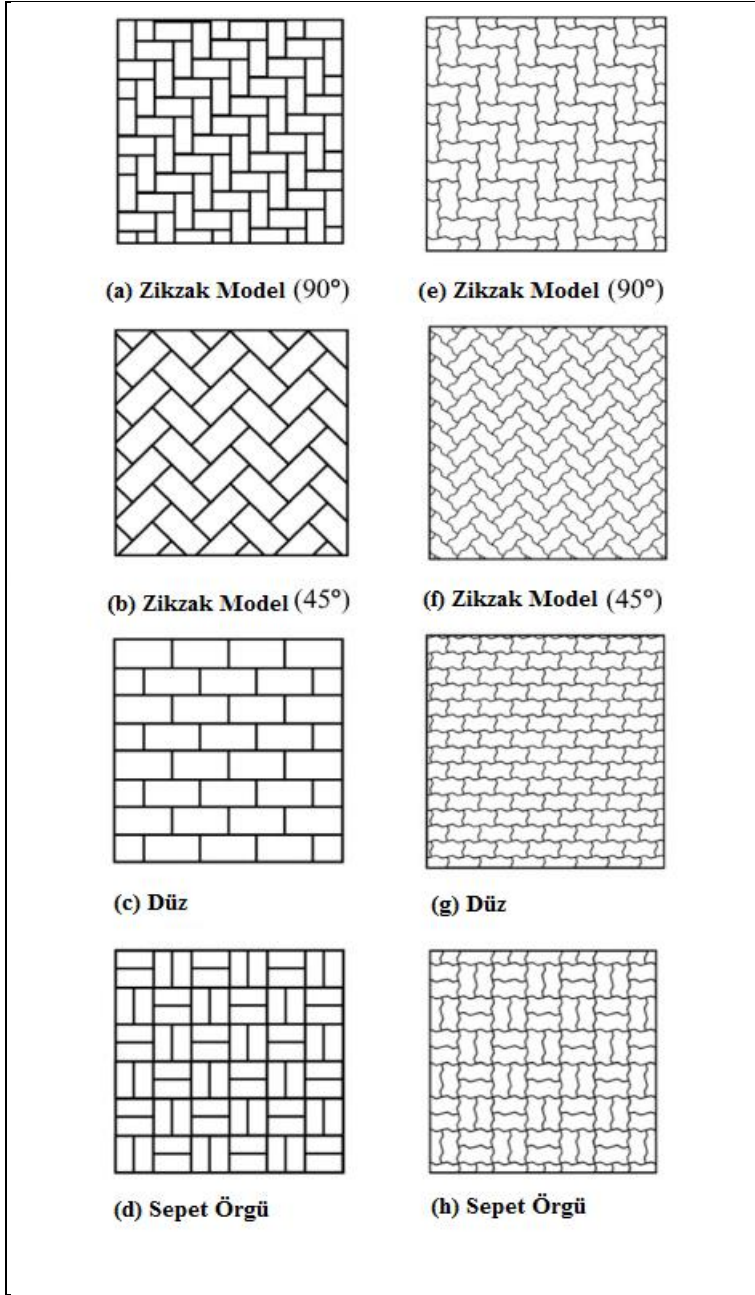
Beton parke çeşitleri (URL-2, 2018)
